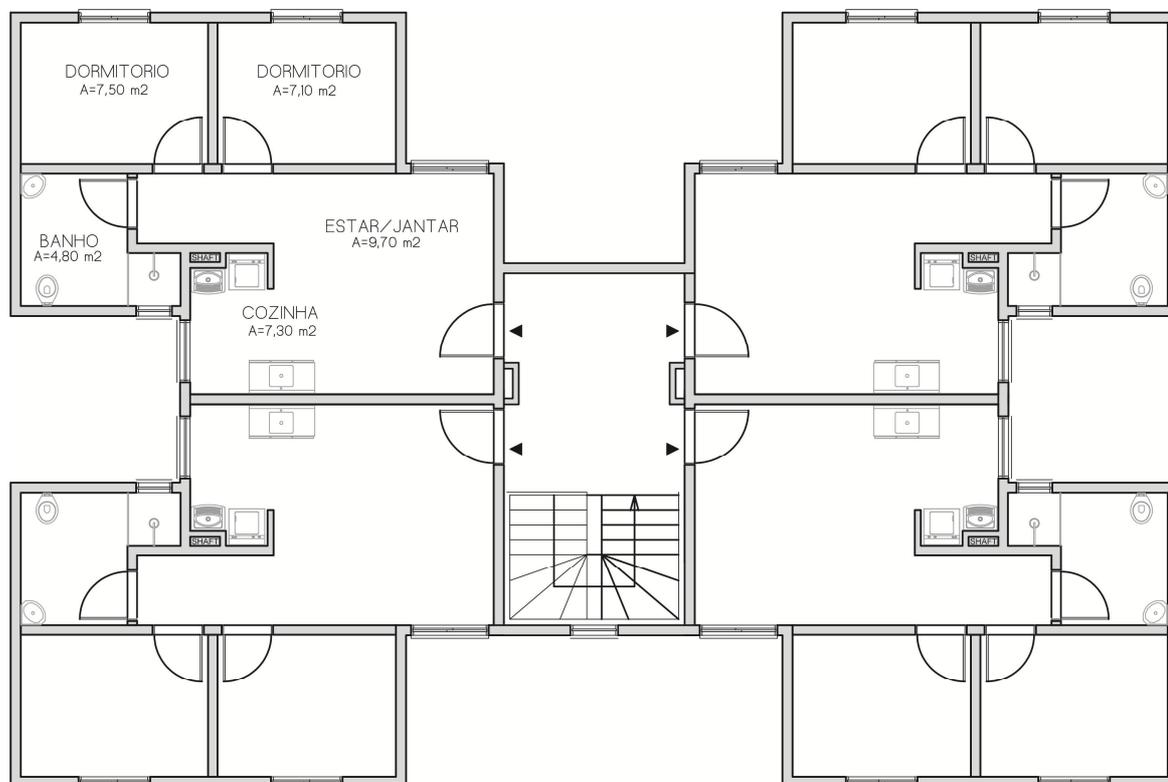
Planta baixa do pavimento tipo do Projeto-base (escala indeterminada).
